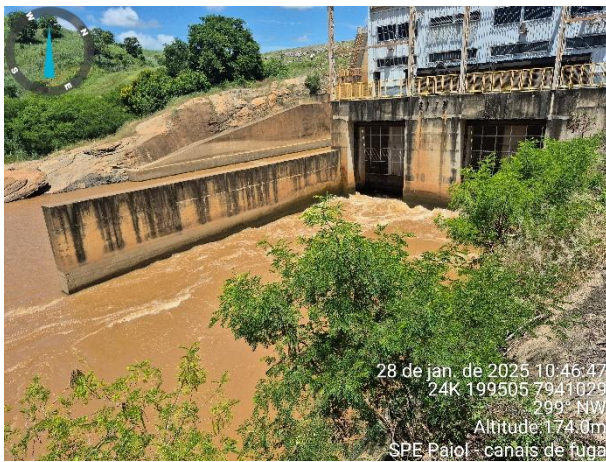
Canal de fuga ao lado da Casa de Força, sem trecho de vazão reduzida.
